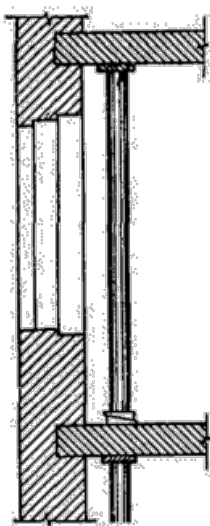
Вывешивание балок перекрытия, опирающихся на перемычку
